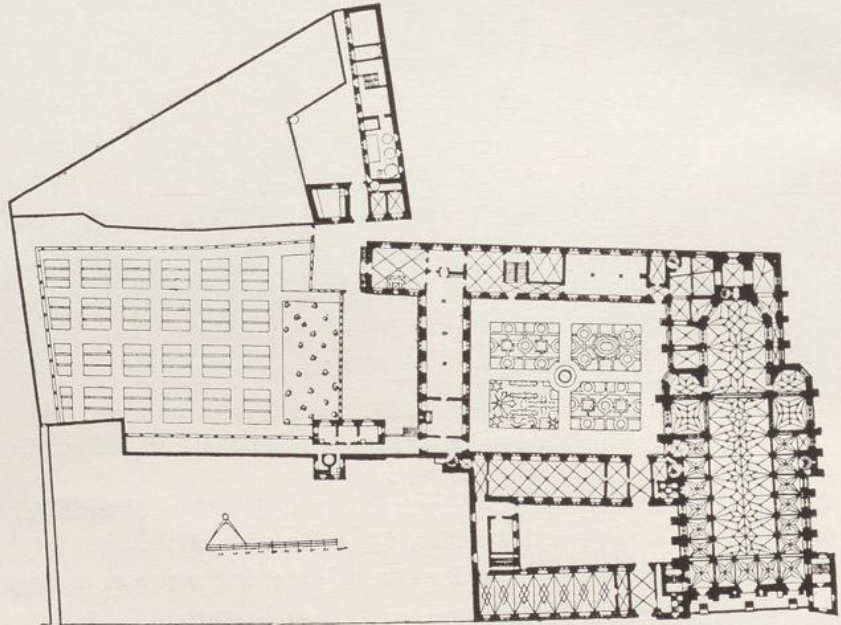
Grundriss des ehem. Jesuitenkollegs, nach einer Zeichnung des 17. Jh.
